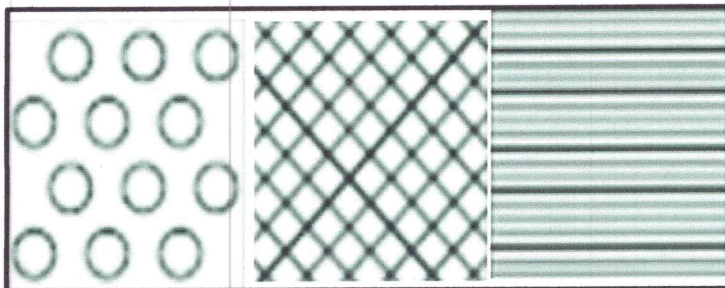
Dalles podotactile (dalle d'éveil à la vigilance/dalle de conduite/dalle d'information)
